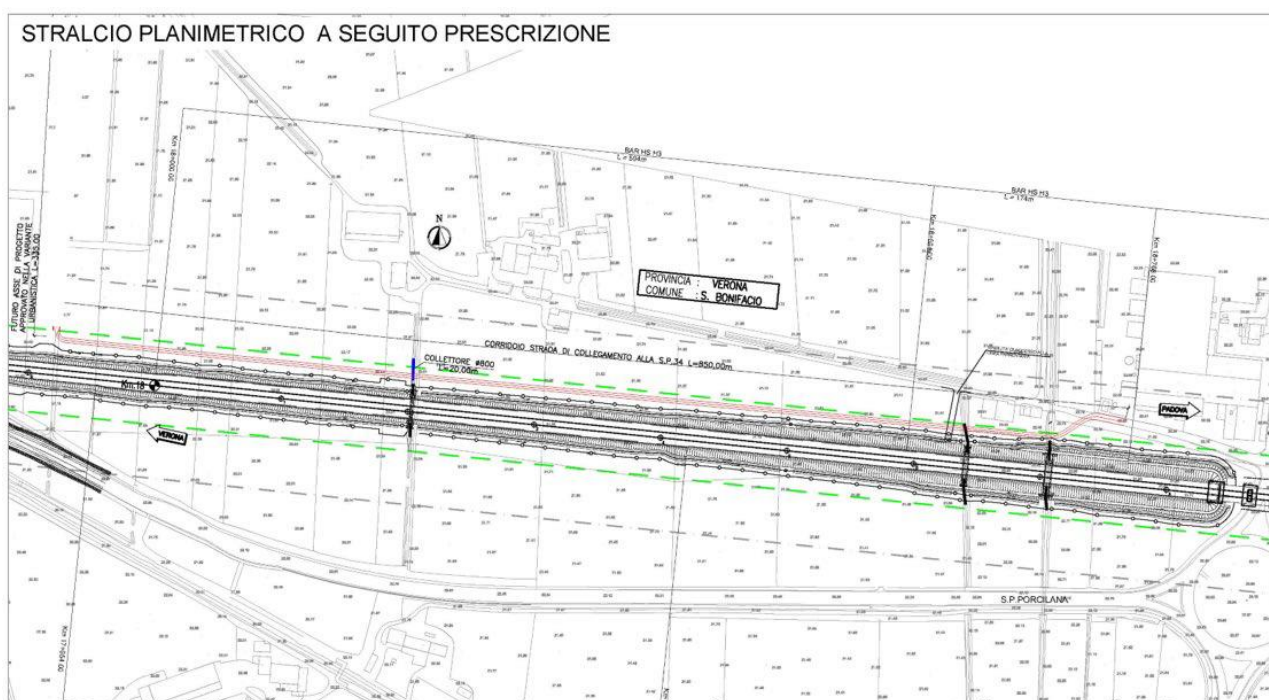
Variante pr. 30 - Realizzazione strada di collegamento tra variante urbanistica 70 (pk 18) e viabilità esistente
